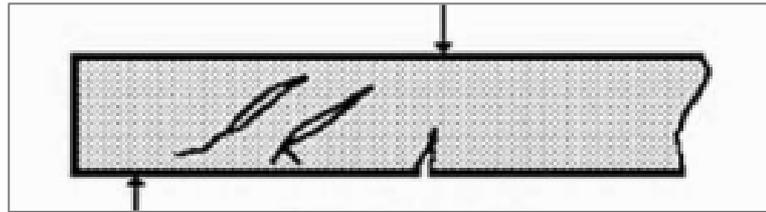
Configuração genérica de fissuras por flexão em vigas
